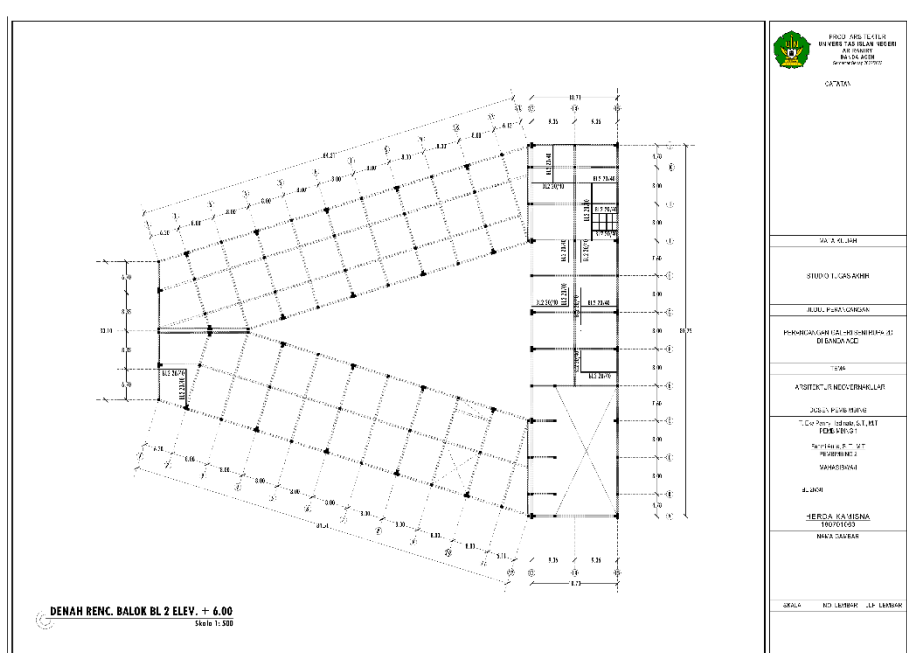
48 Denah Rencana Balok BL 1 Elev. +6.00
